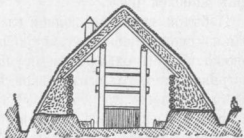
Поперечный разрез через лабаз для хранения овощей. Посредине полки. Снаружи две водоотводные канавы.
